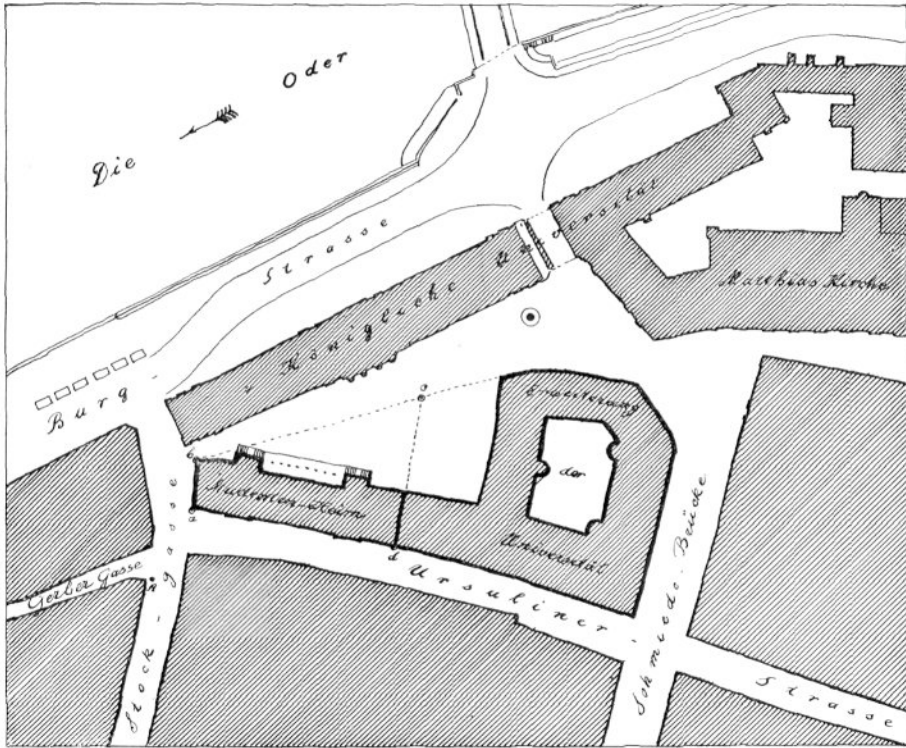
Lageplan nach dem Vorschlage des Herrn Stadtbaurats Berg
